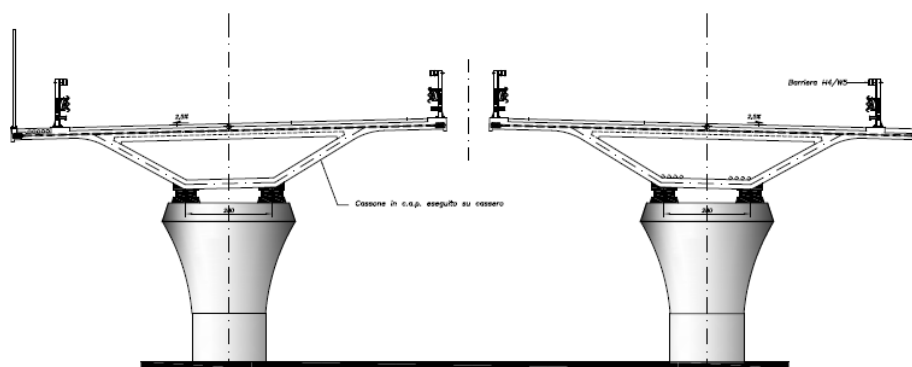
sezione trasversale dell'impalcato in c.a.p.
